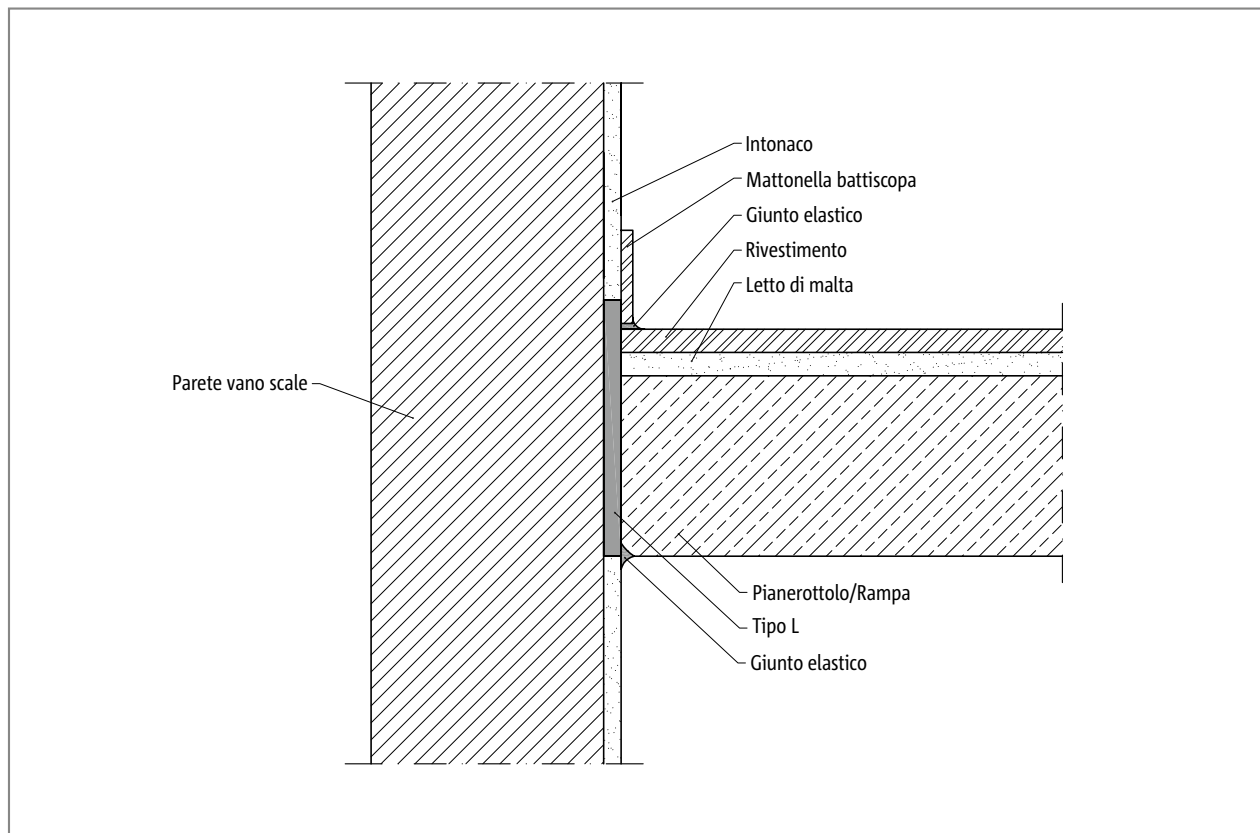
Schöck Tronsole® tipo L: sezione costruttiva - scale in opera
